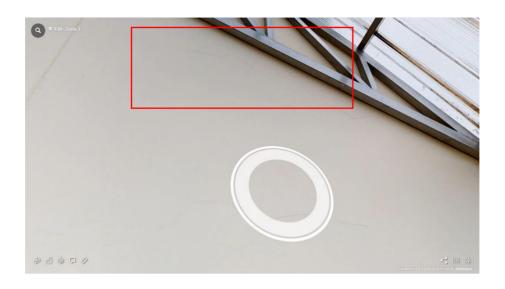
Deposito 4C (Fisura en la pared)
